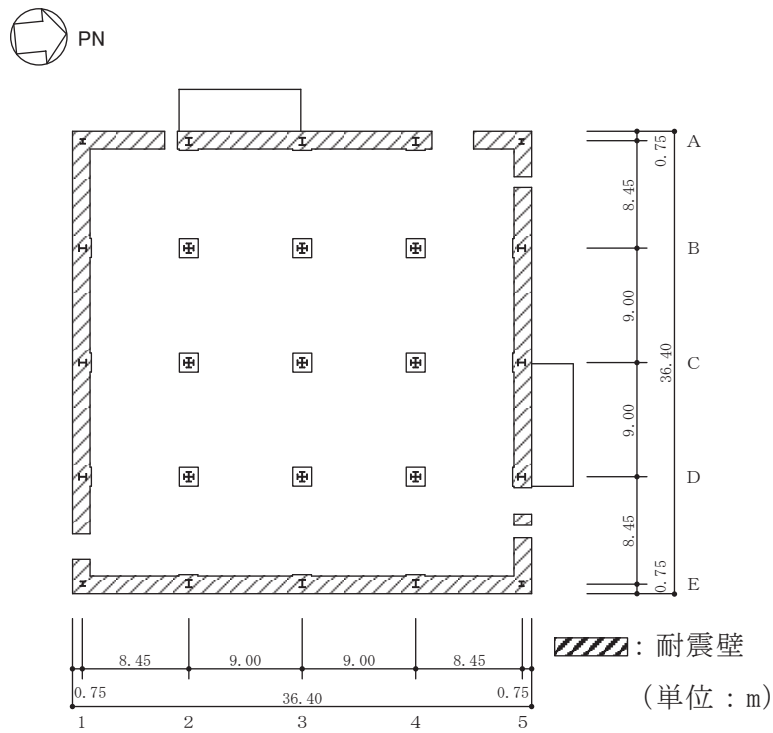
(3) 耐震壁の評価を記載する部材の位置 (1F, O.P.62.2m)
